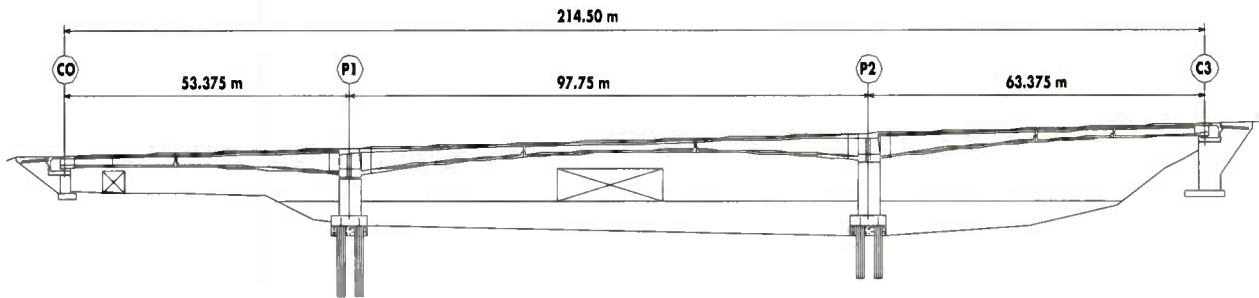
Coupe longitudinale de l'ouvrage
